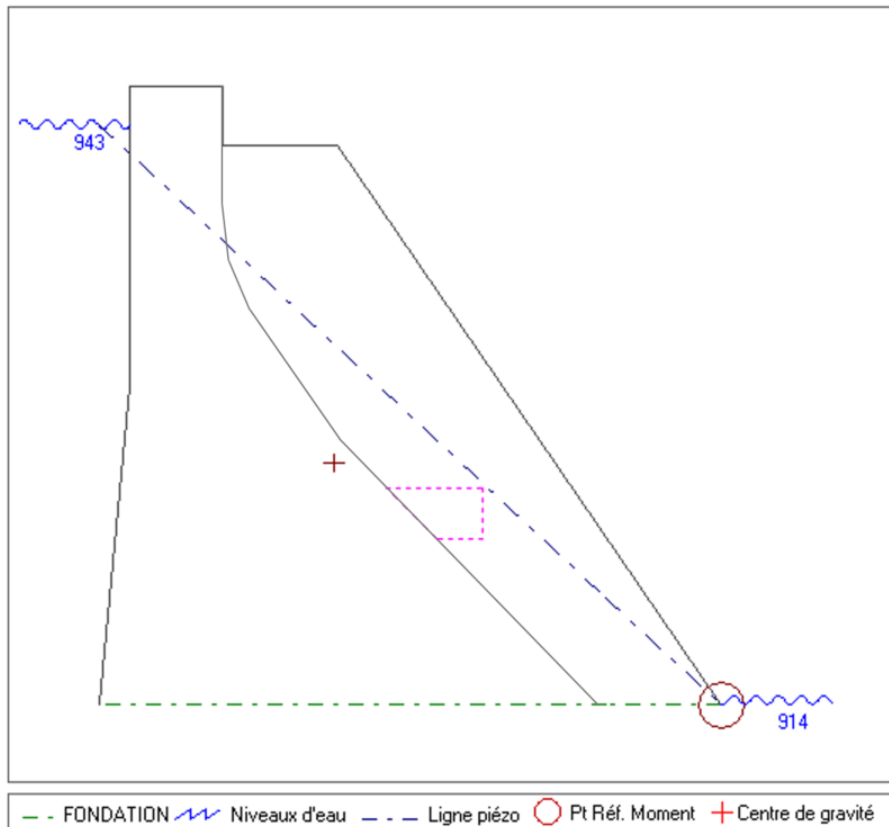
Exemple de profil de sous-pression en l'absence de dispositif de drainage (Profil de calcul du barrage en phase travaux – Situation de défaillance de drainage)
